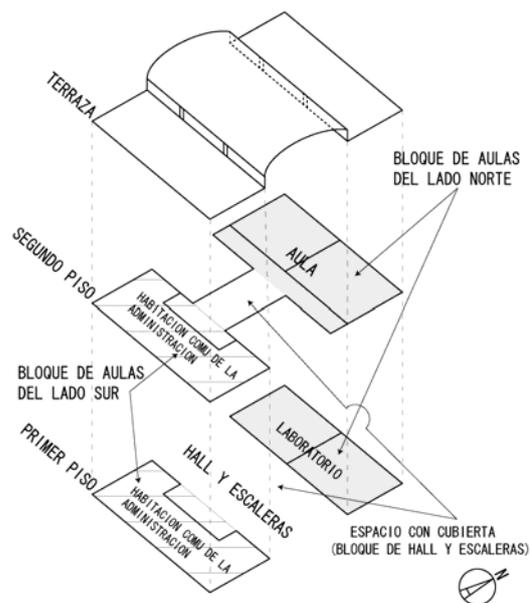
Plan de Planta de la Escuela de Auxiliares de Enfermería
